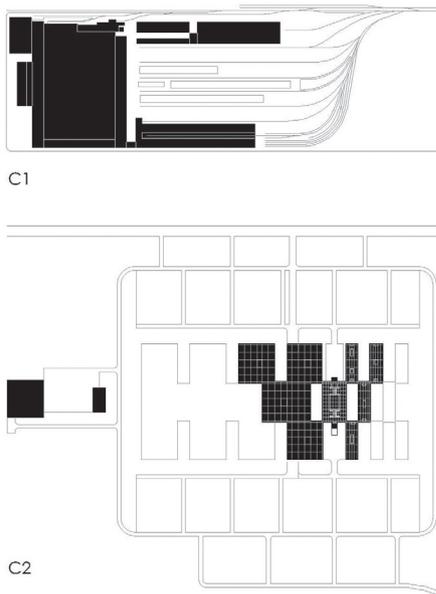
El campus compacto 1. Arriba, planta de la fábrica Ford de Highland Park, de Albert Kahn, 1914. Abajo, planta del Centro para IBM en Rochester, de Eero Saarinen, 1956-58.
